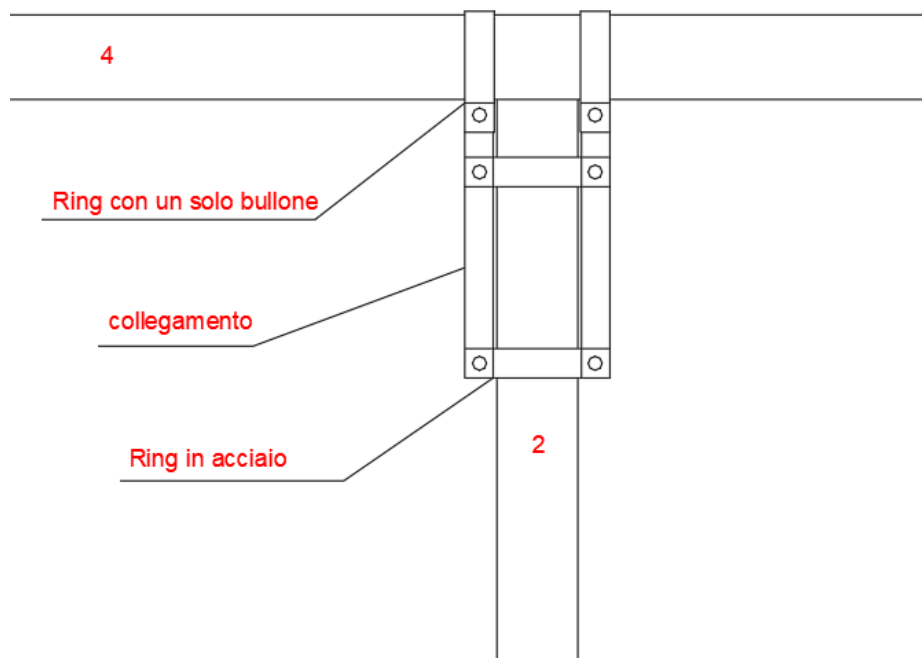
Giunto di collegamento tra un culmo della trave ed uno del pilastro sul quale essa poggia.
